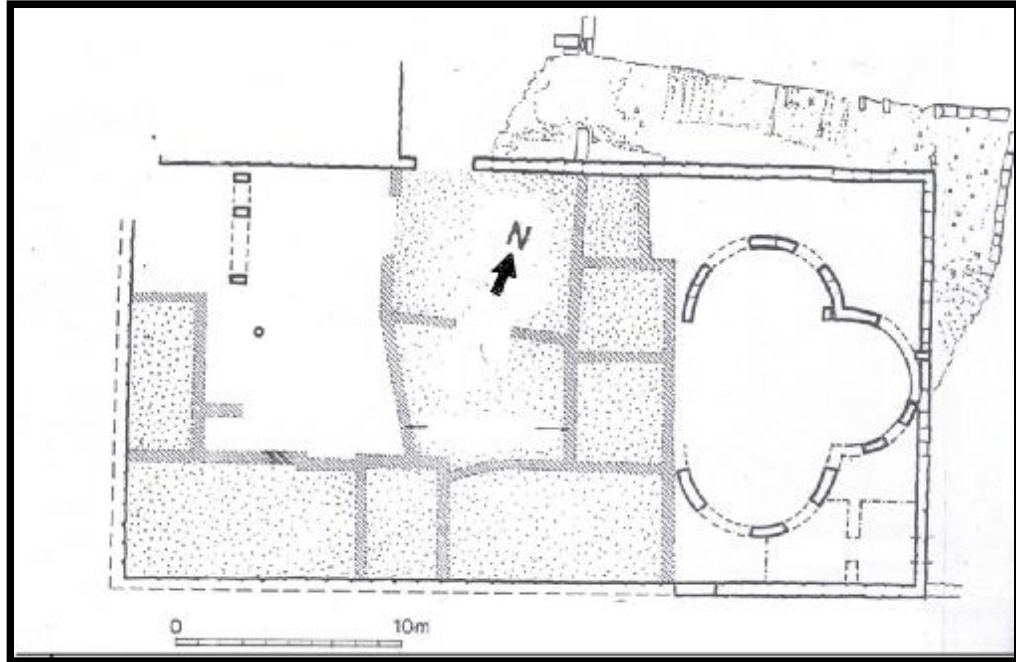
مسقط أفقي لمبنى المجمع الأمامي في الكنيسة الغربية
